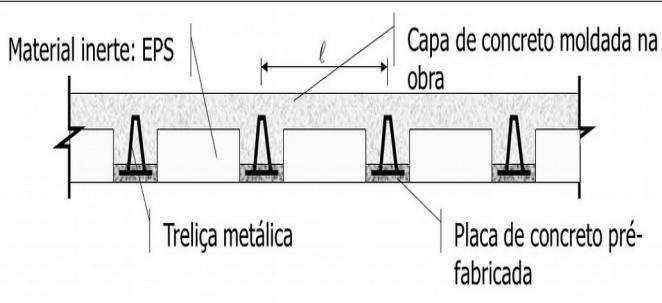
Esquema da seção transversal de uma laje treliçada de concreto armado
